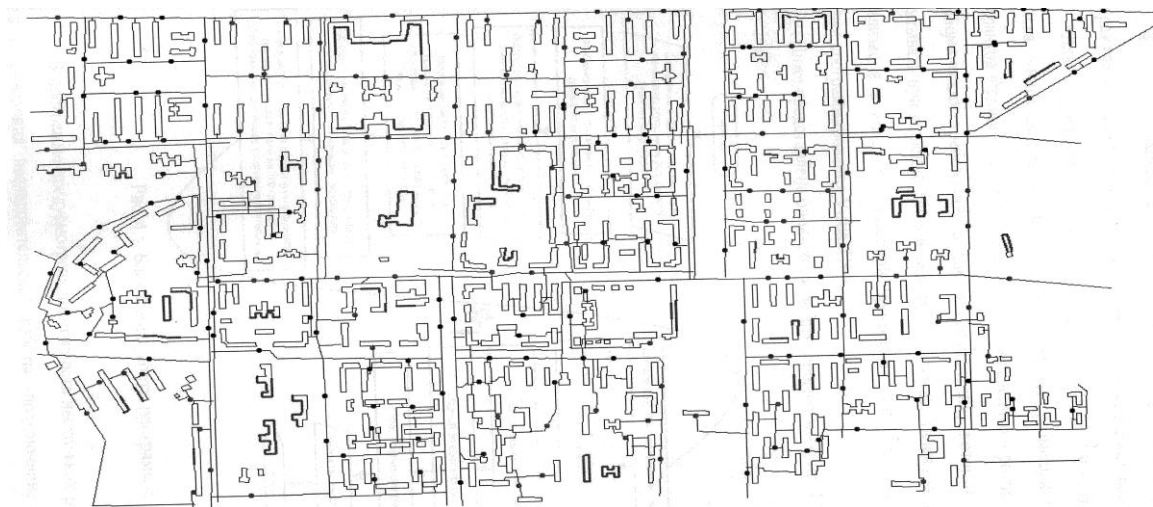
Размещение пожарных гидрантов (точки на водопроводной сети) в Орджоникидзевском районе г. Харькова
